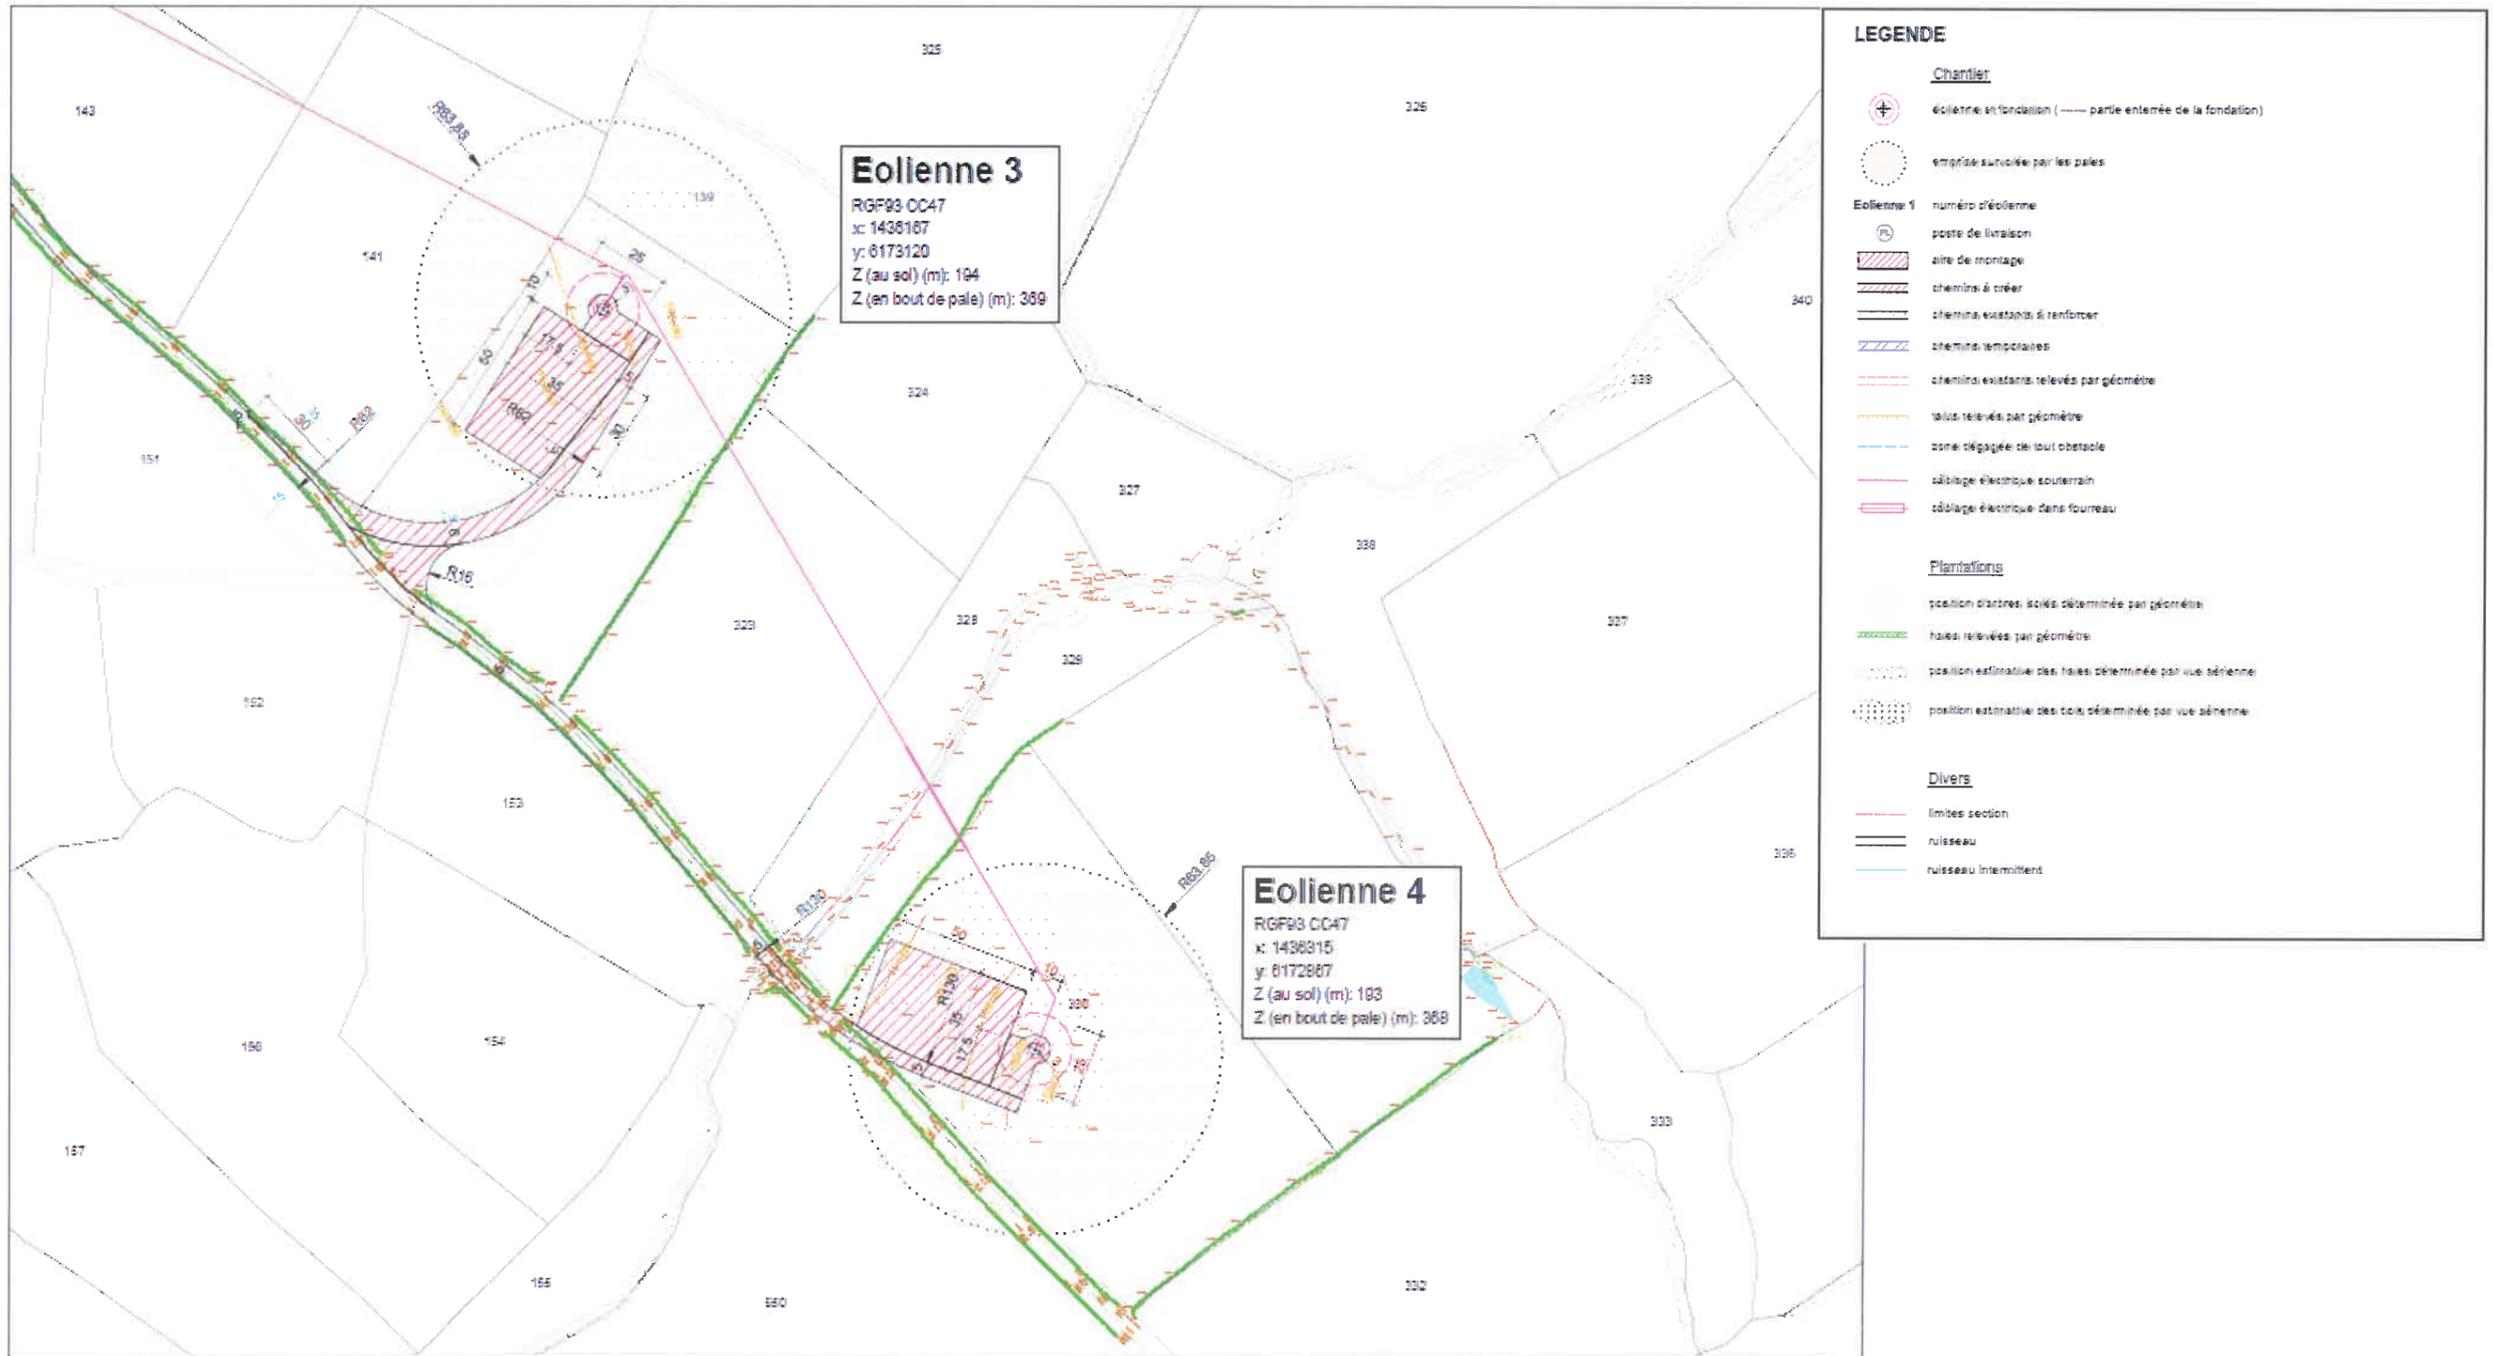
Plan de masse – Zoom sur les éoliennes E3 et E4
